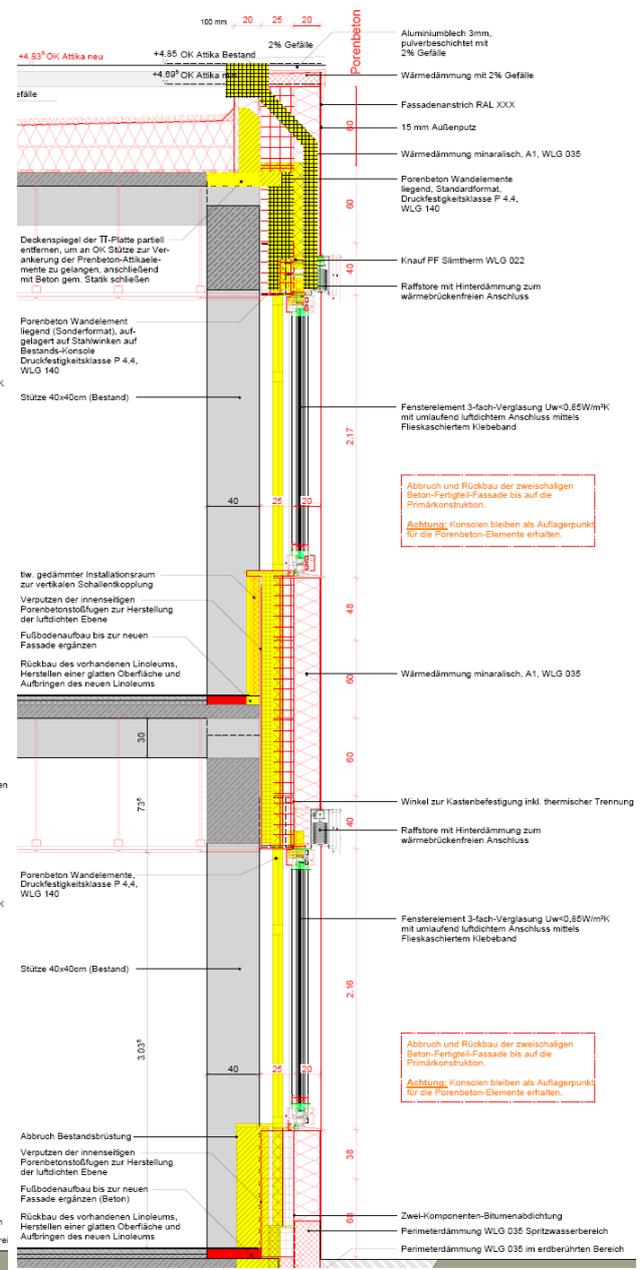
Bild 3.9 mit Darstellung der abzubrechenden Bauteile (gelb) [U2]
